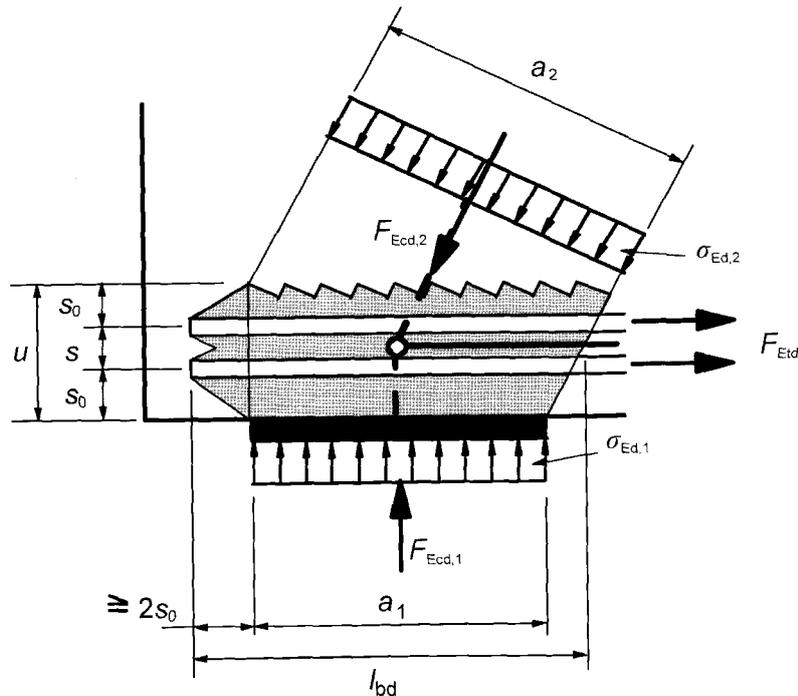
Druck-Zug-Knoten mit Bewehrung in einer Richtung
